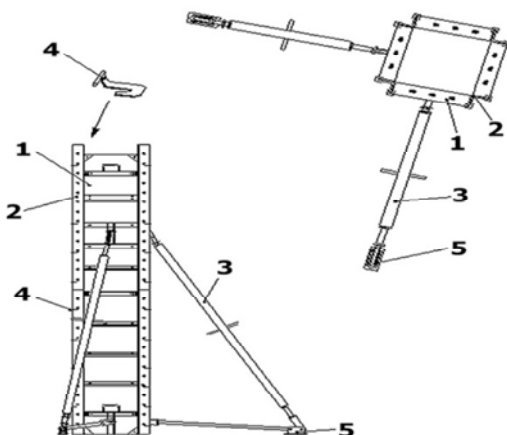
Схема устройства опалубки прямоугольных колонн из щитов МОДОСТР-КОМБИ:
